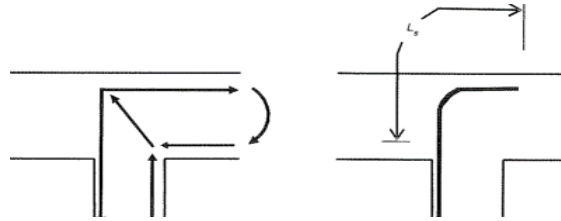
Detalle de anclaje de la armadura de la pila hacia el interior de la misma
